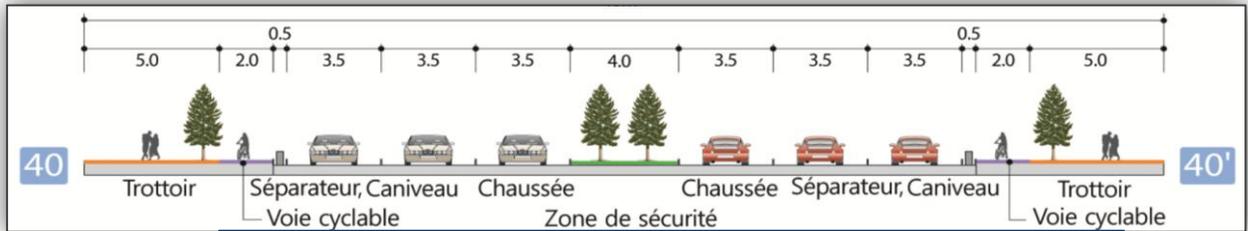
la coupe AA' d'une voie principale à Bouinan.
